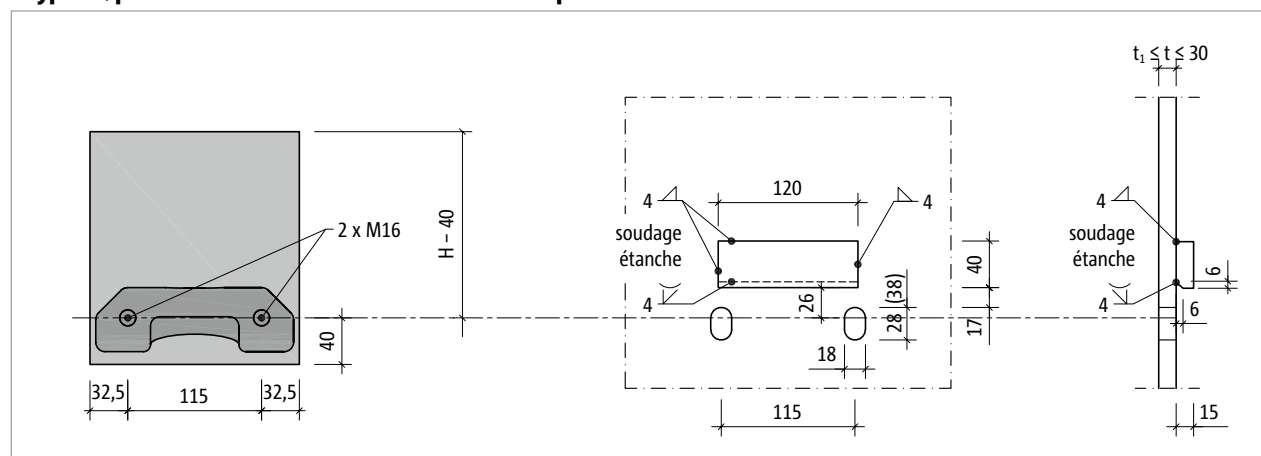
Schöck Isokorb® T type SQ : construction de la platine frontale de raccordement
